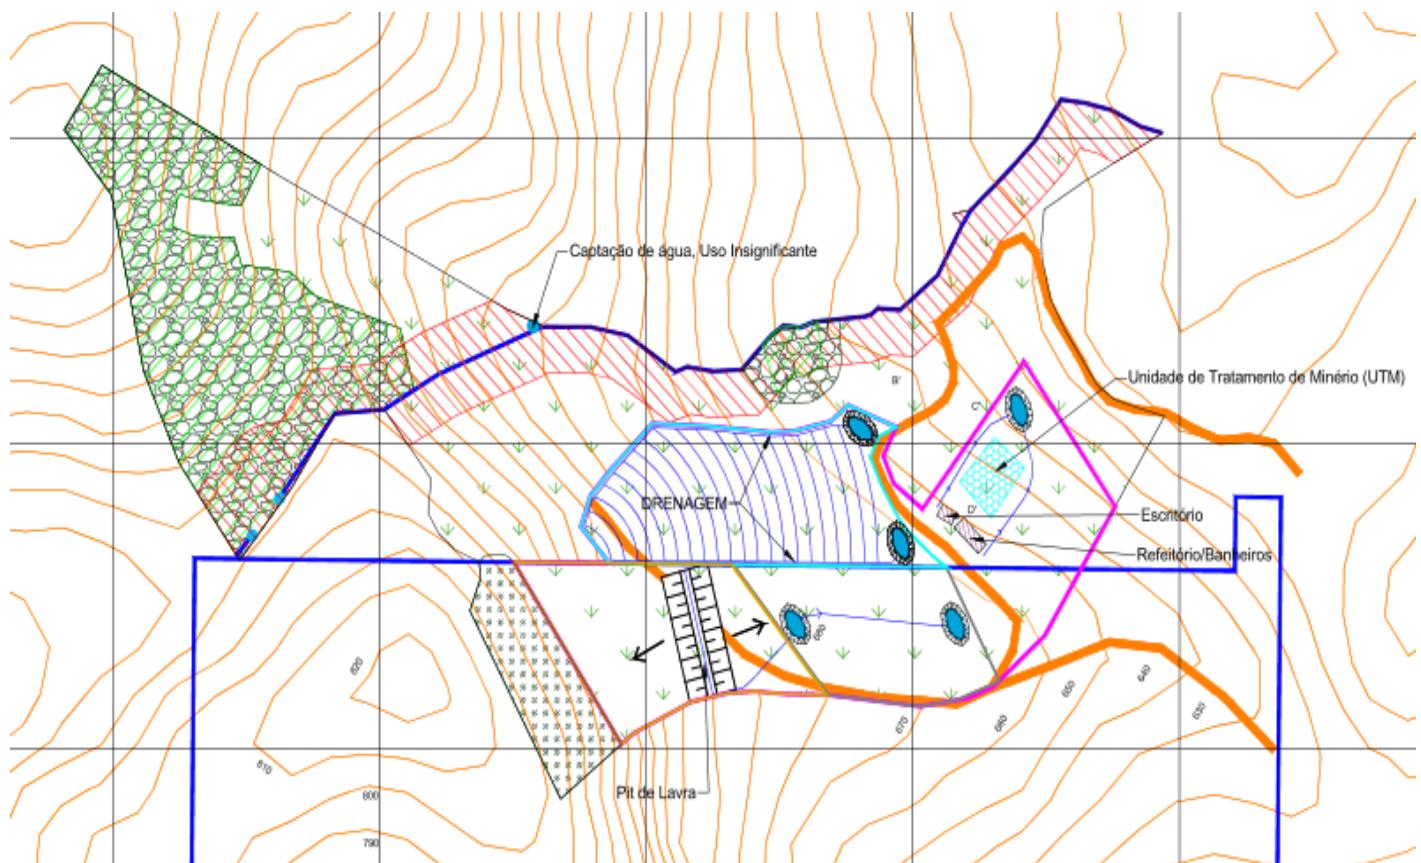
imagem da planta planimétrica georreferenciada do empreendimento
